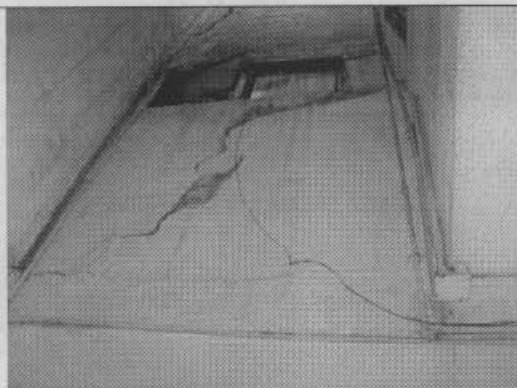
Deformaciones en fachada interior, con agrietamiento severo de muros.
